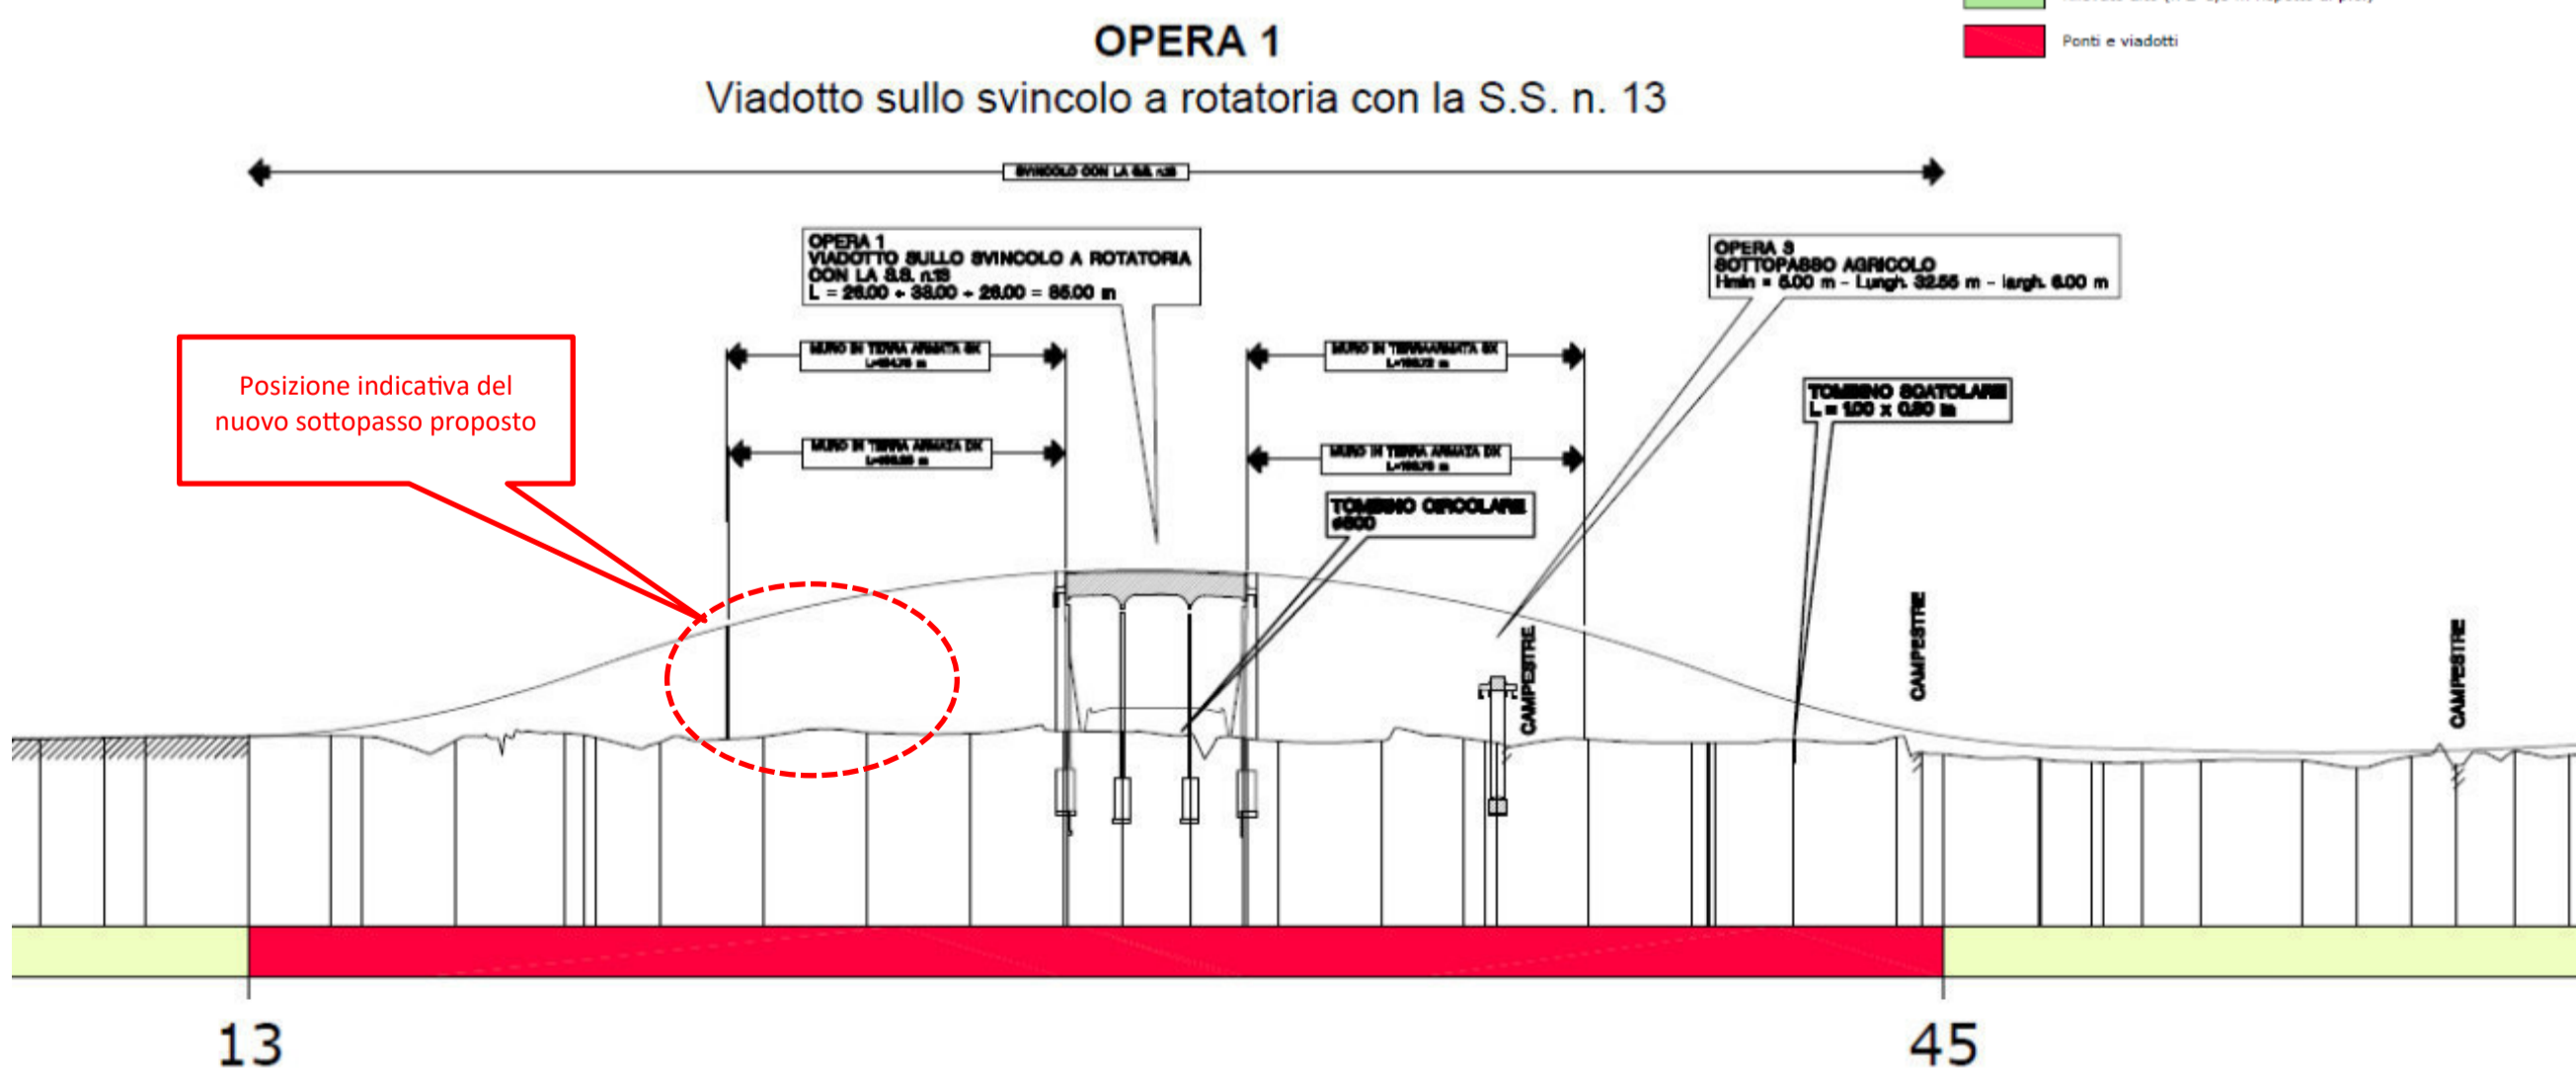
Estratto del profilo dell'infrastruttura di progetto presso l'opera 1
